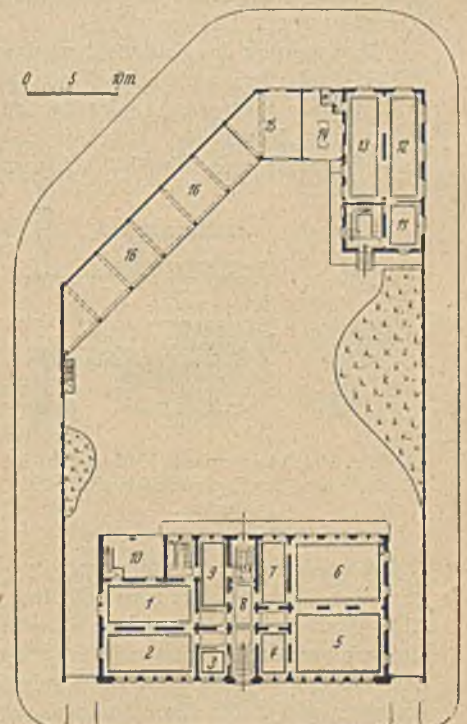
Erdgeschoß-Grundriß der Anlage.
